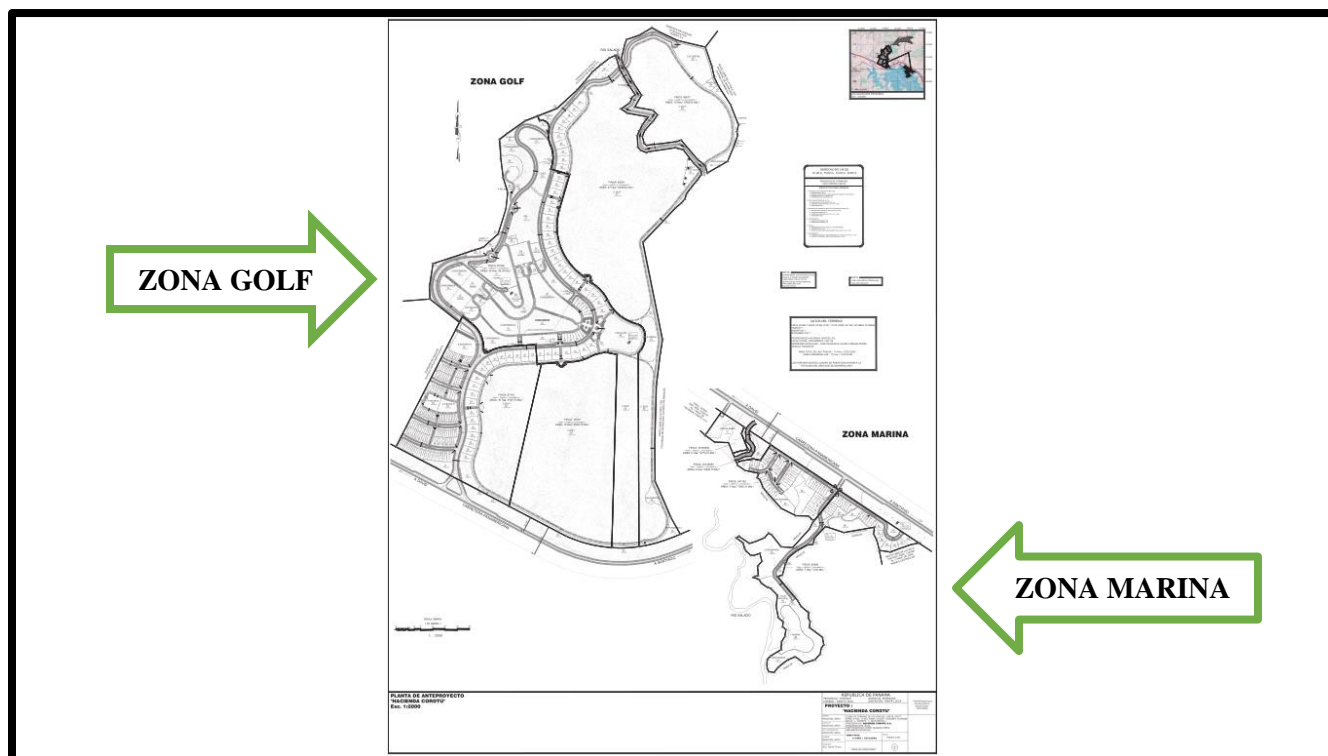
Globos de terreno a desarrollar HACIENDA COROTÚ. / Fuente: Planos del proyecto. 2024
